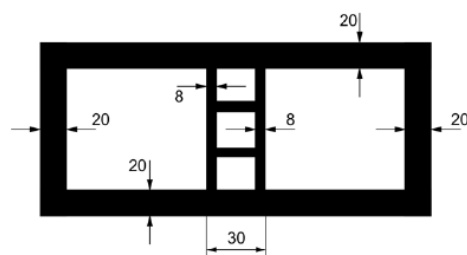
Planta do bloco estrutural vazado com paredes maciças
